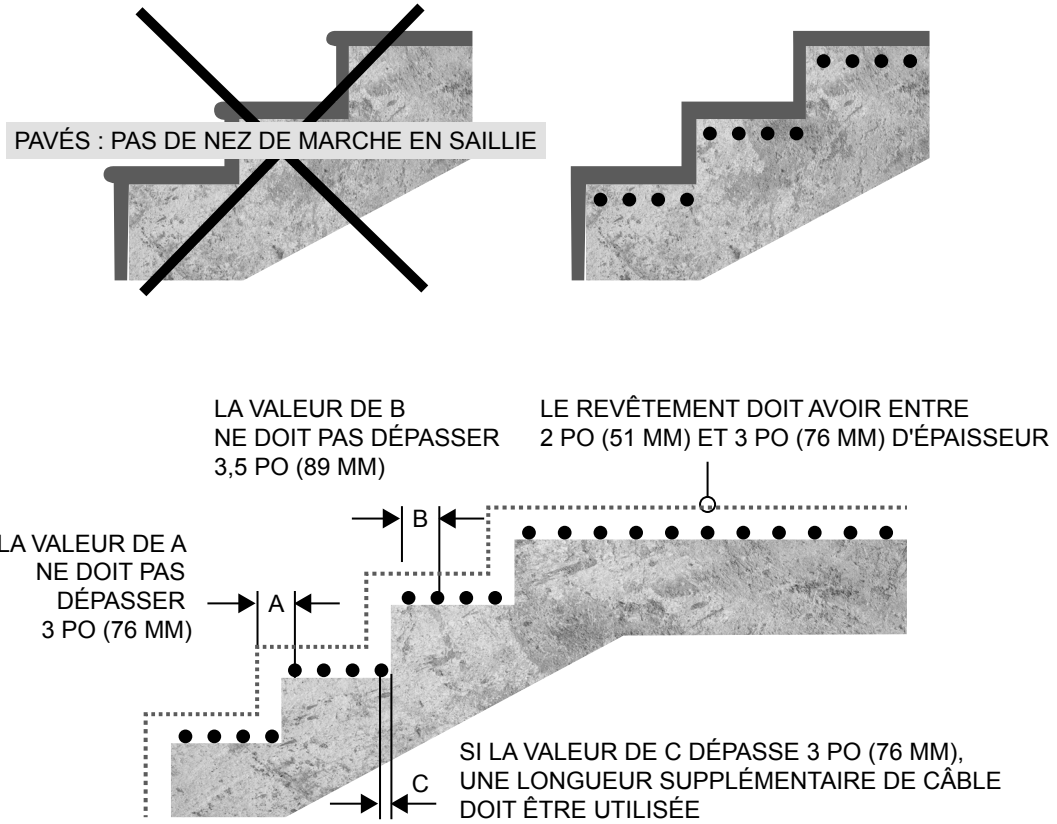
Vue en coupe d'un câble chauffant dans des escaliers
